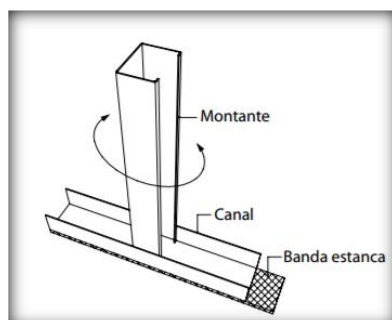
Explicación colocación canal, montante y banda estanca. [Pladur]
